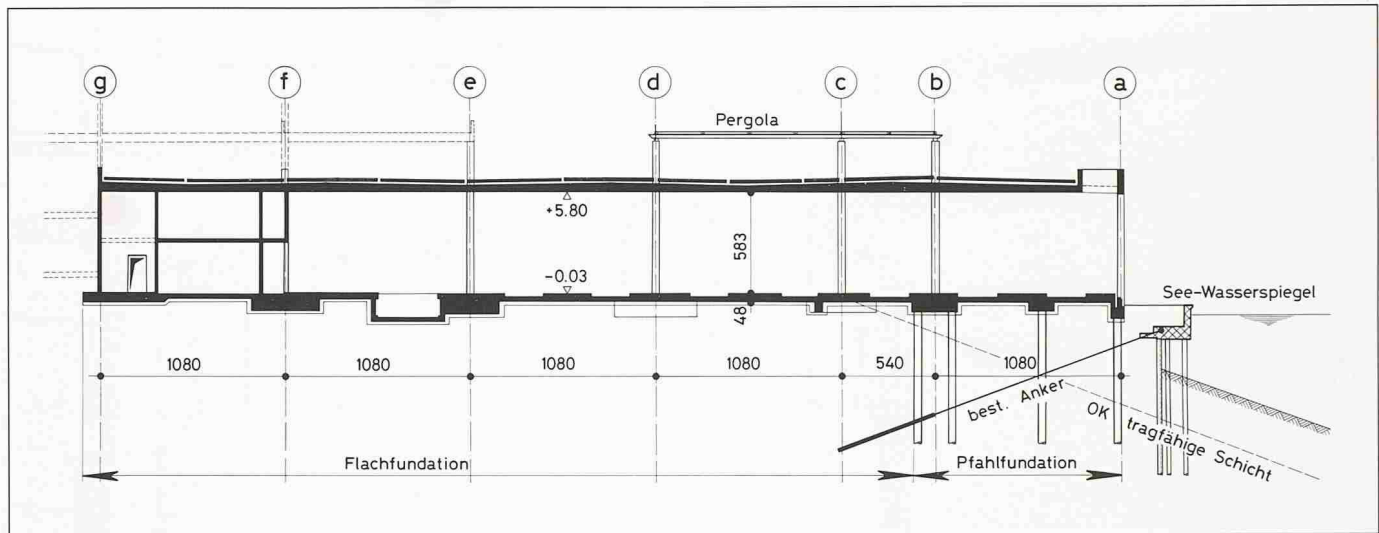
Querschnitt durch Gebäude (senkrecht zum See) mit Ufermauer inkl. Erdanker, Baugrund, Pfählung, Flachfundation usw.
